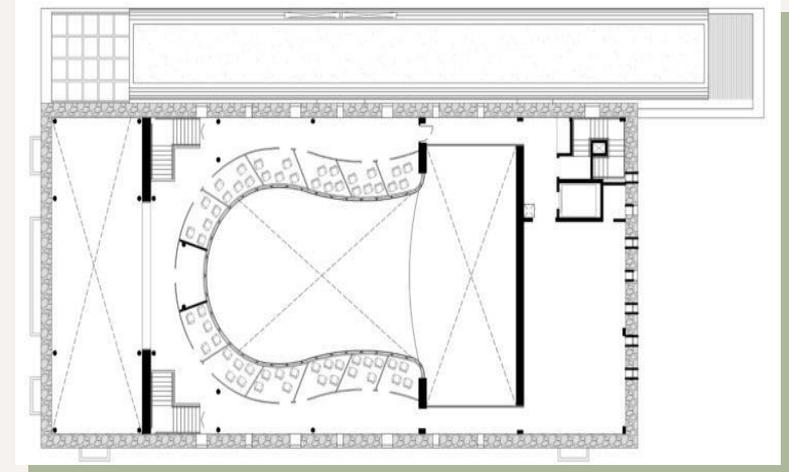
PLANTA 2º PAV. DO PROJETO DE RESTAURO DO TEATRO GUARANY.
